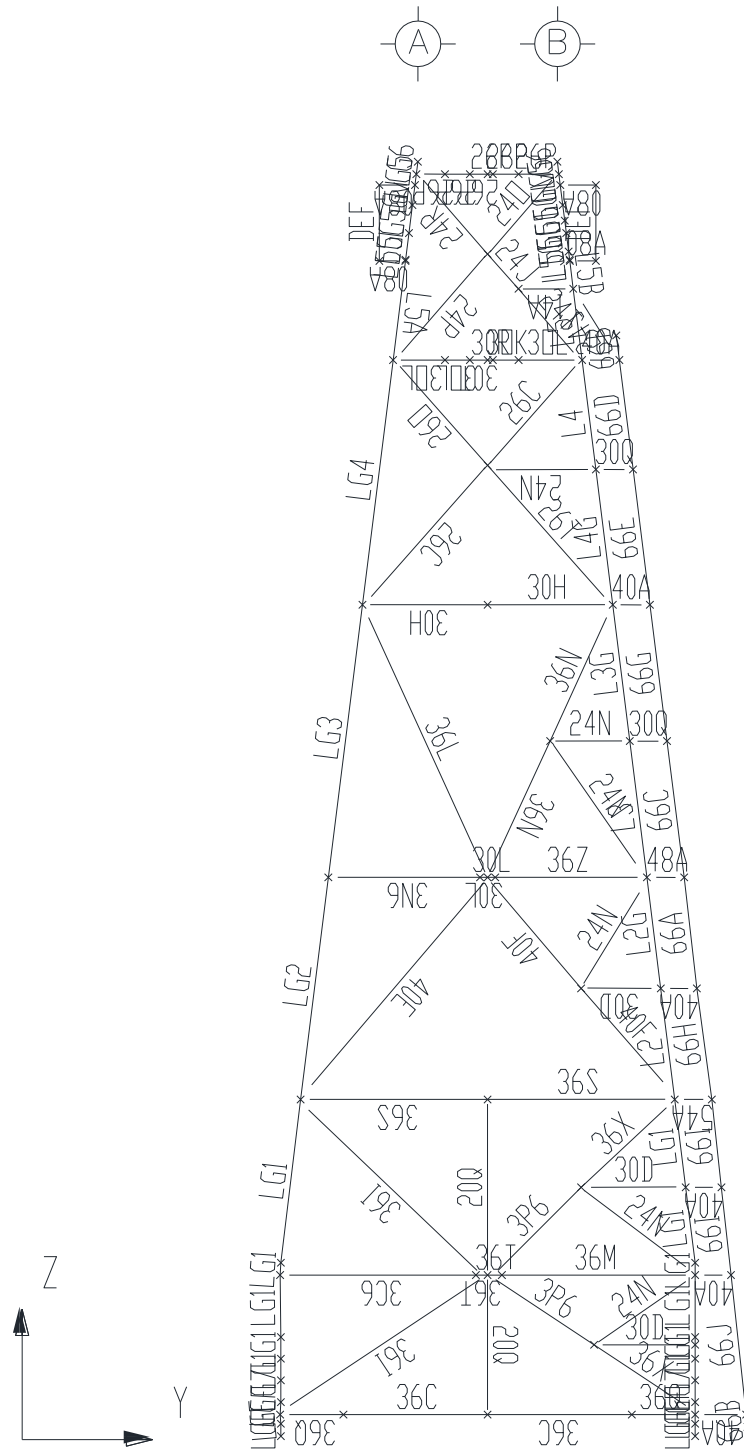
Grupos en marco transversal Eje 3, subestructura
